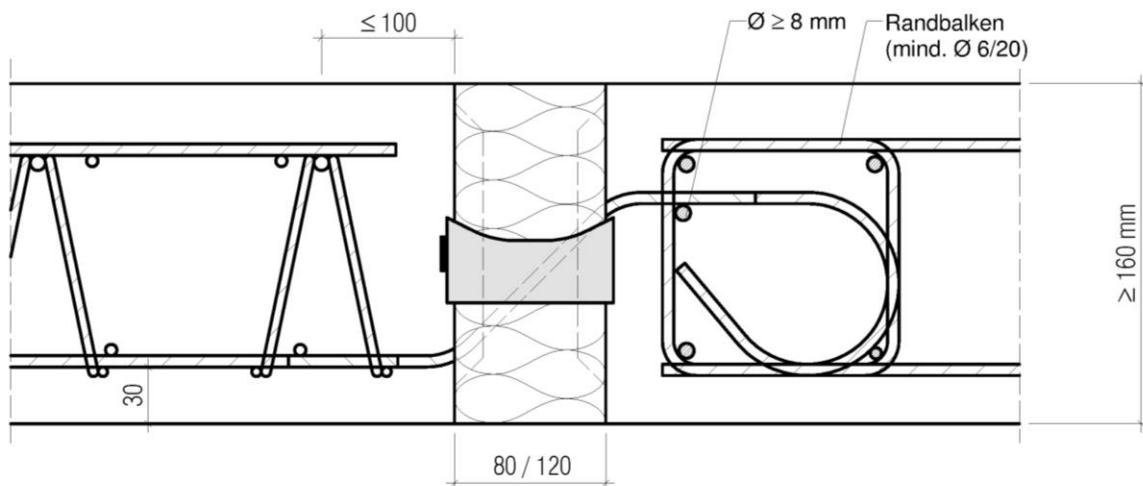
Beispiel Schöck Isokorb® Typ Q mit Aufhängebewehrung nach Abschn. 3.1.5 und Ausführung als Randbalken.
